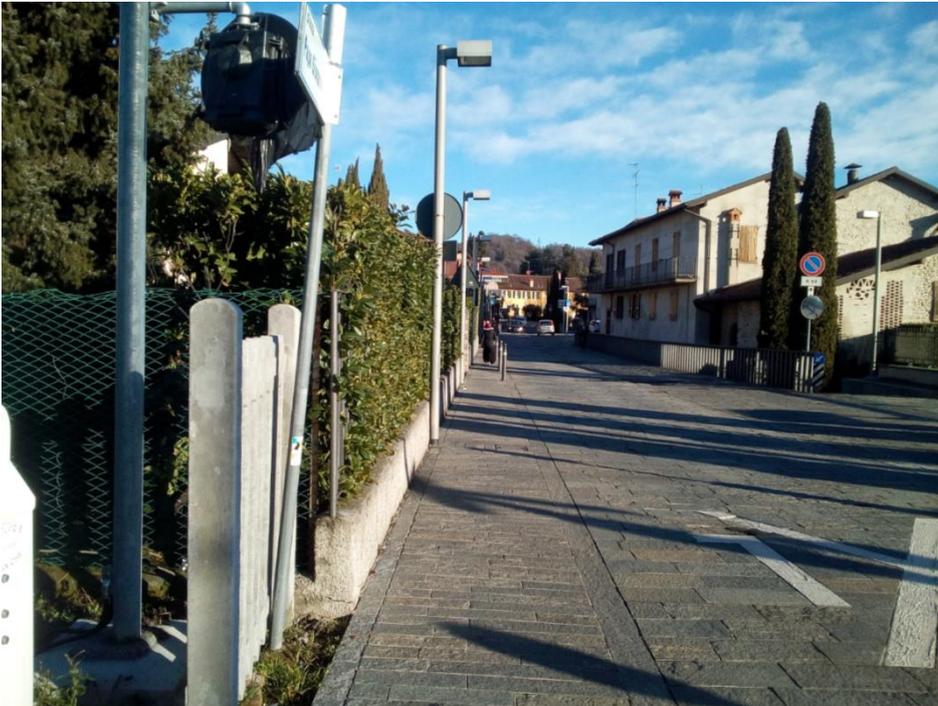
Vista del cantiere 1.AT.01 (fonte sopralluogo)
